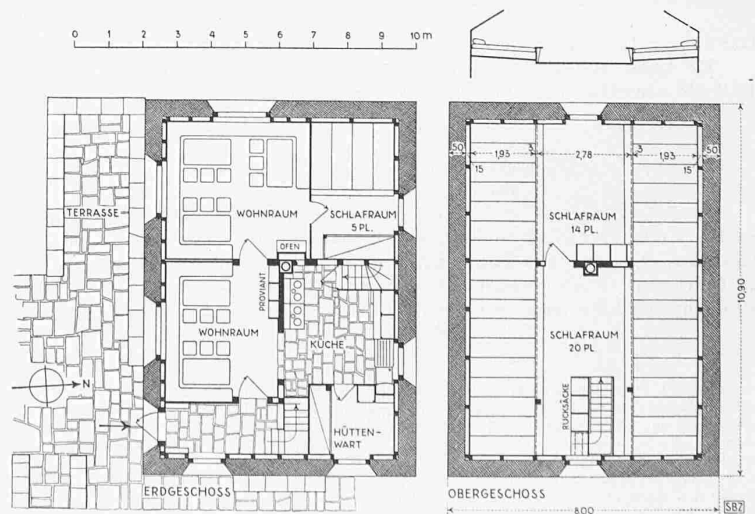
Medelserhütte, Grundrisse und Schlafruamschnitt 1:200
